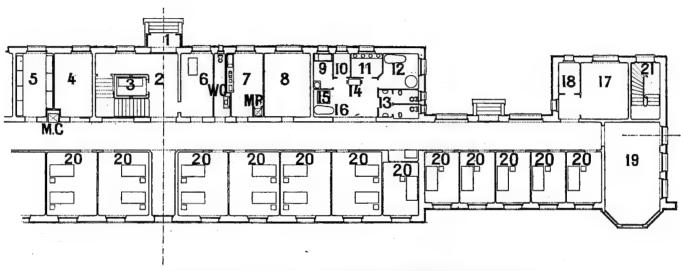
Pavillon de contagieux civils (hommes). Plan du rez-de-chaussée.
